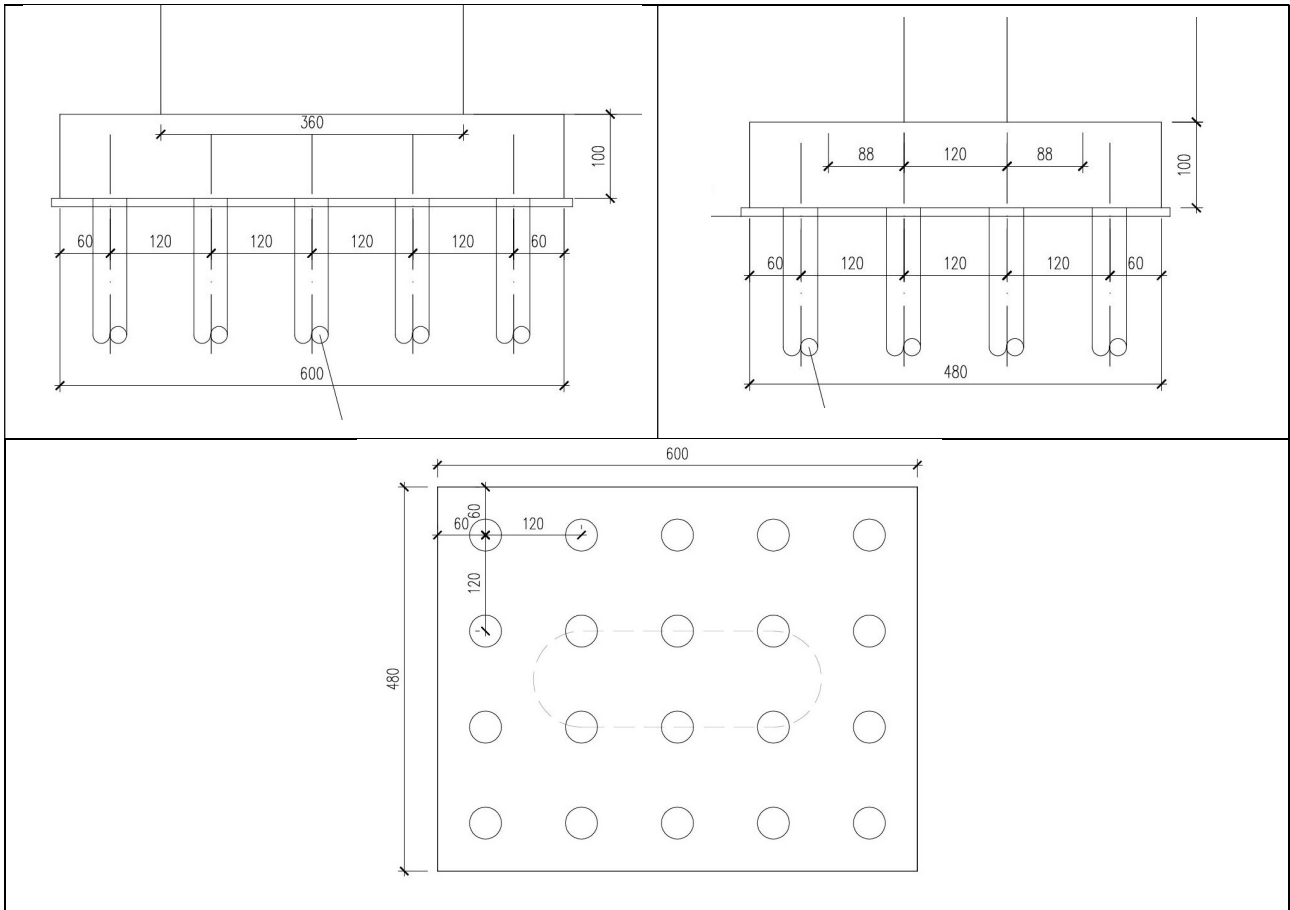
Plinto pila 2: vista frontale, vista laterale e pianta
